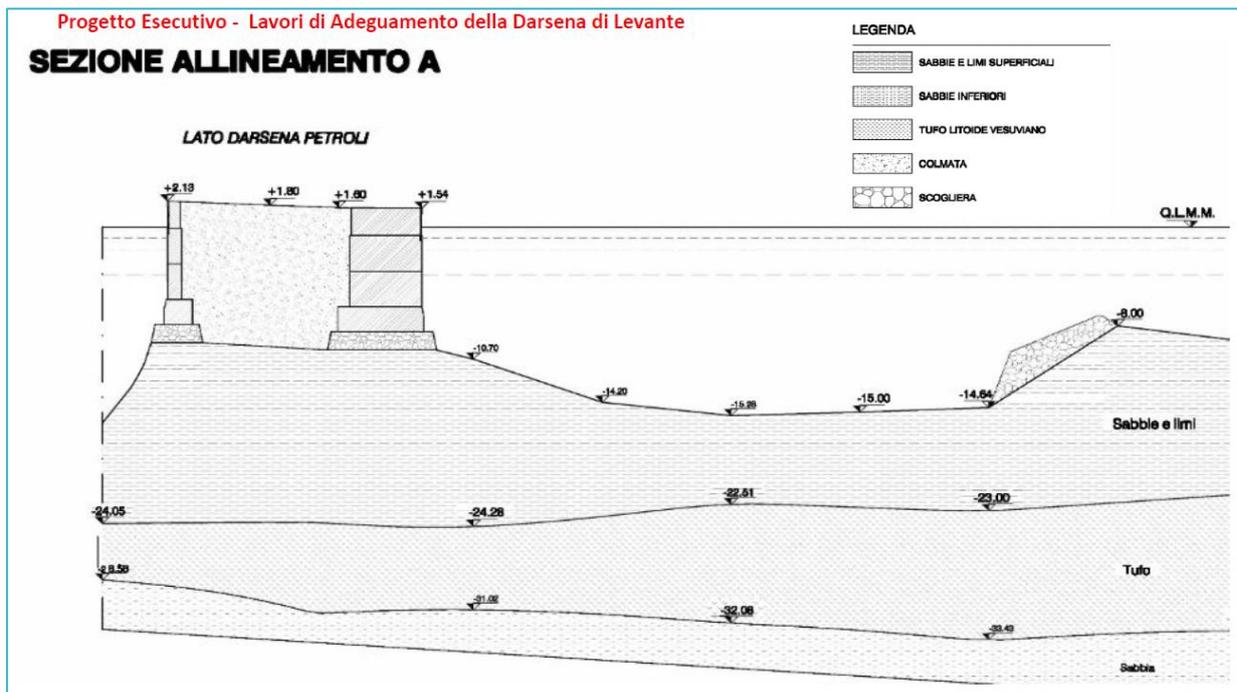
Sezione Stratigrafica tratta dal Progetto Esecutivo dei Lavori di Adeguamento della Darsena di Levante
